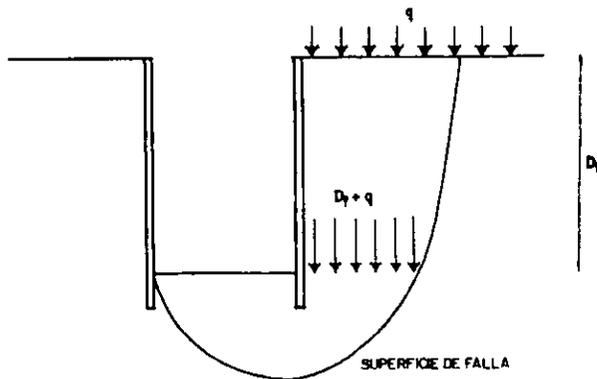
Mecanismo de falla de fondo en excavaciones en arcilla.
